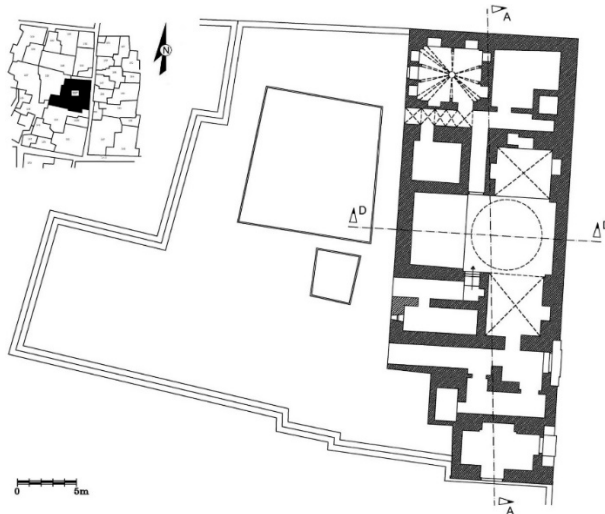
La demeure Müfid al-'Āmīn: plan actuel du rez-de-chaussée. Ğ. ṬAQṬAQ, 'I. AL-MAṢRI ; I. Fayyad.
